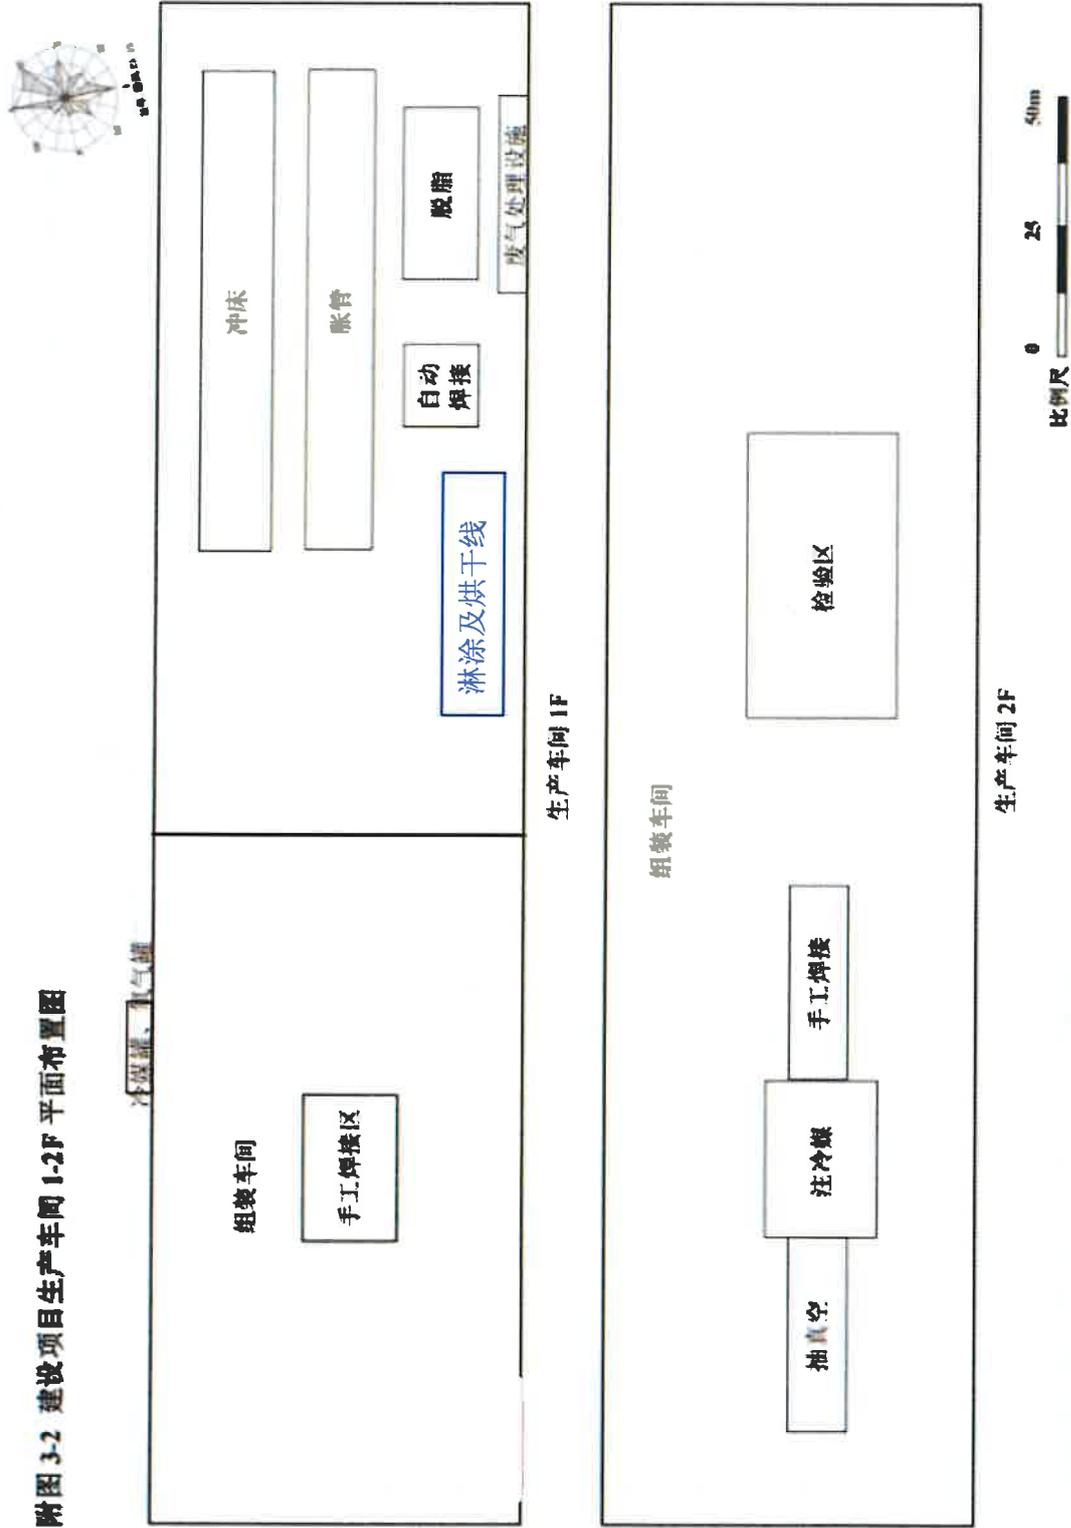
1 号厂房生产车间 1-2 层的平面布置图
